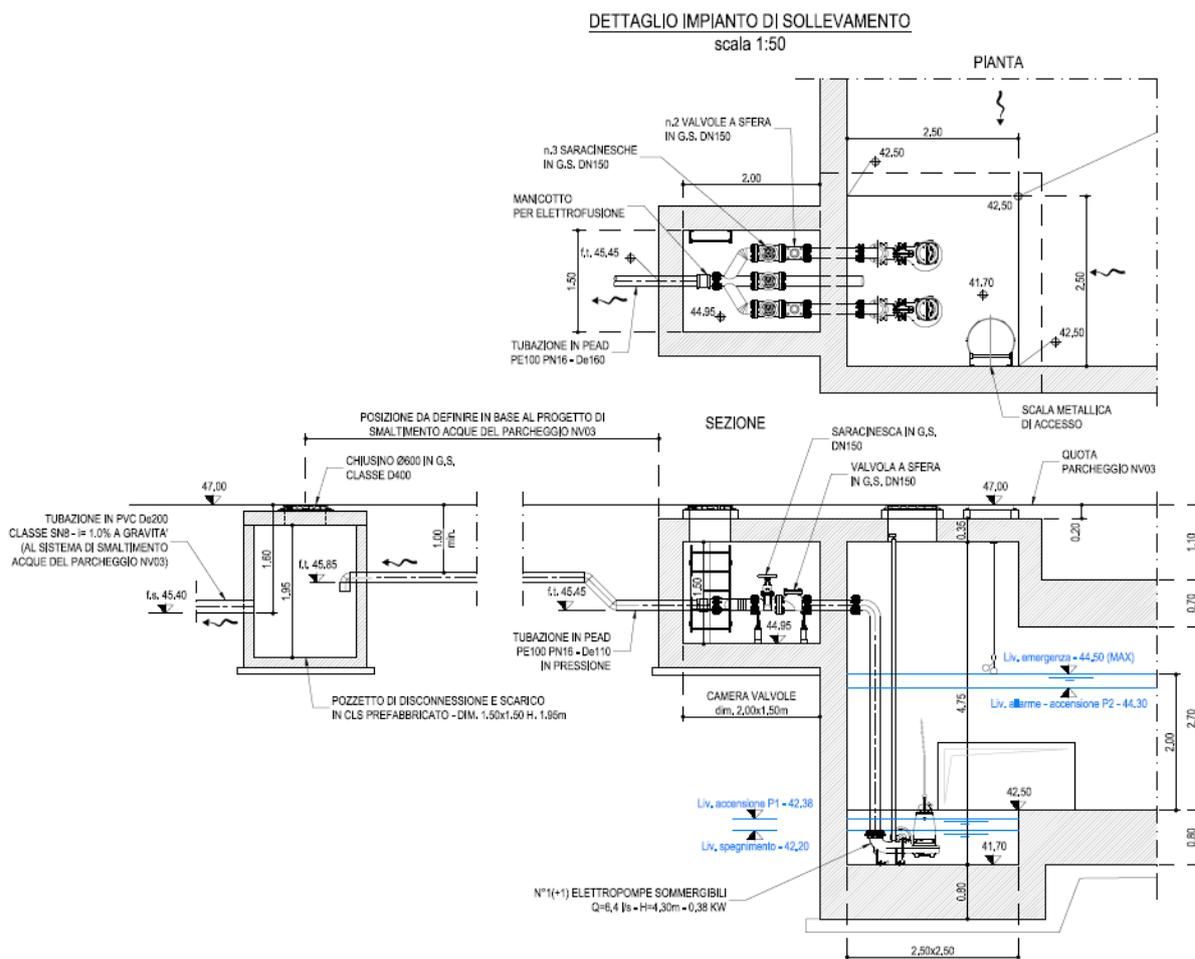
Pianta e sezione dell'impianto di sollevamento annesso alla vasca di laminazione
